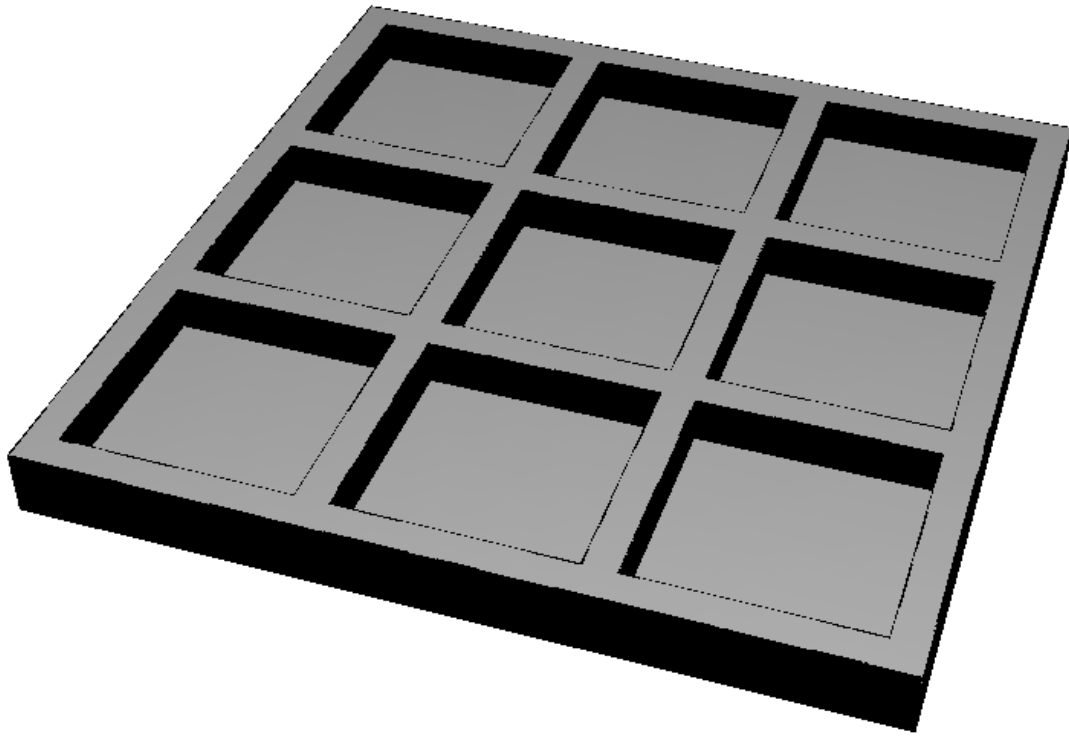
Сталезалізобетонна часторебриста плита зі стрічковим армуванням (в перевернутому положенні)
